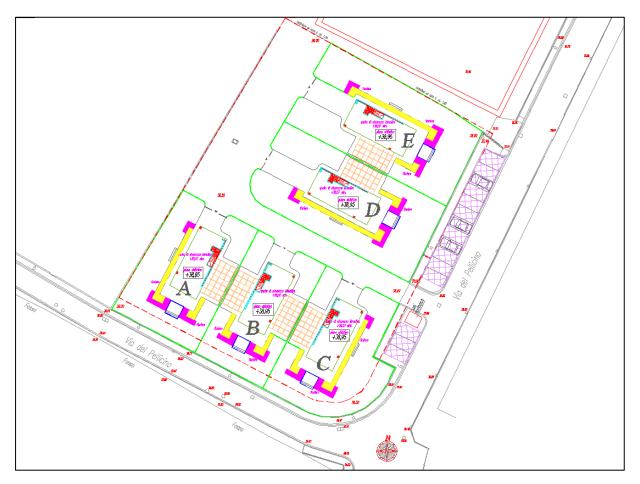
Planimetria di progetto – interventi di messa in sicurezza idraulica e codifica delle aree.
